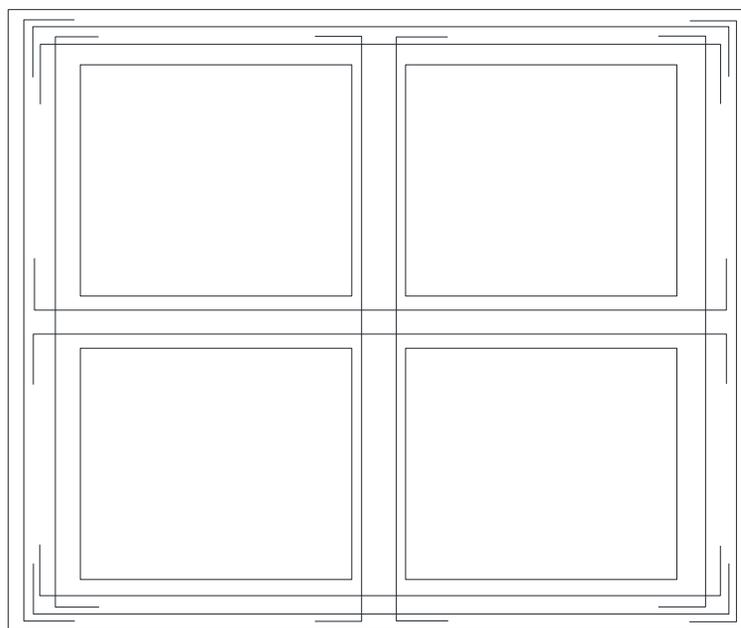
Figura E.2.1-1 Sistema reticular de vigas que configuran anillos cerrados y continuos
